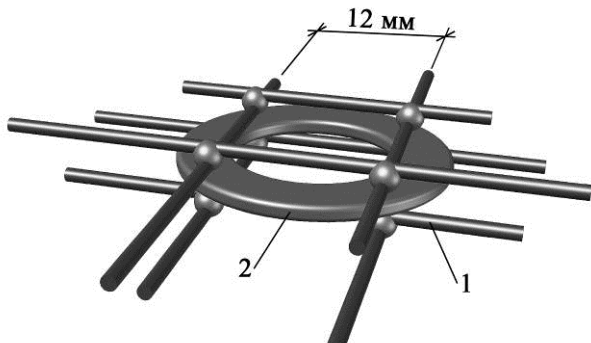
Фрагмент сталевї арматурної сітки / Part of steel reinforcing mesh:
